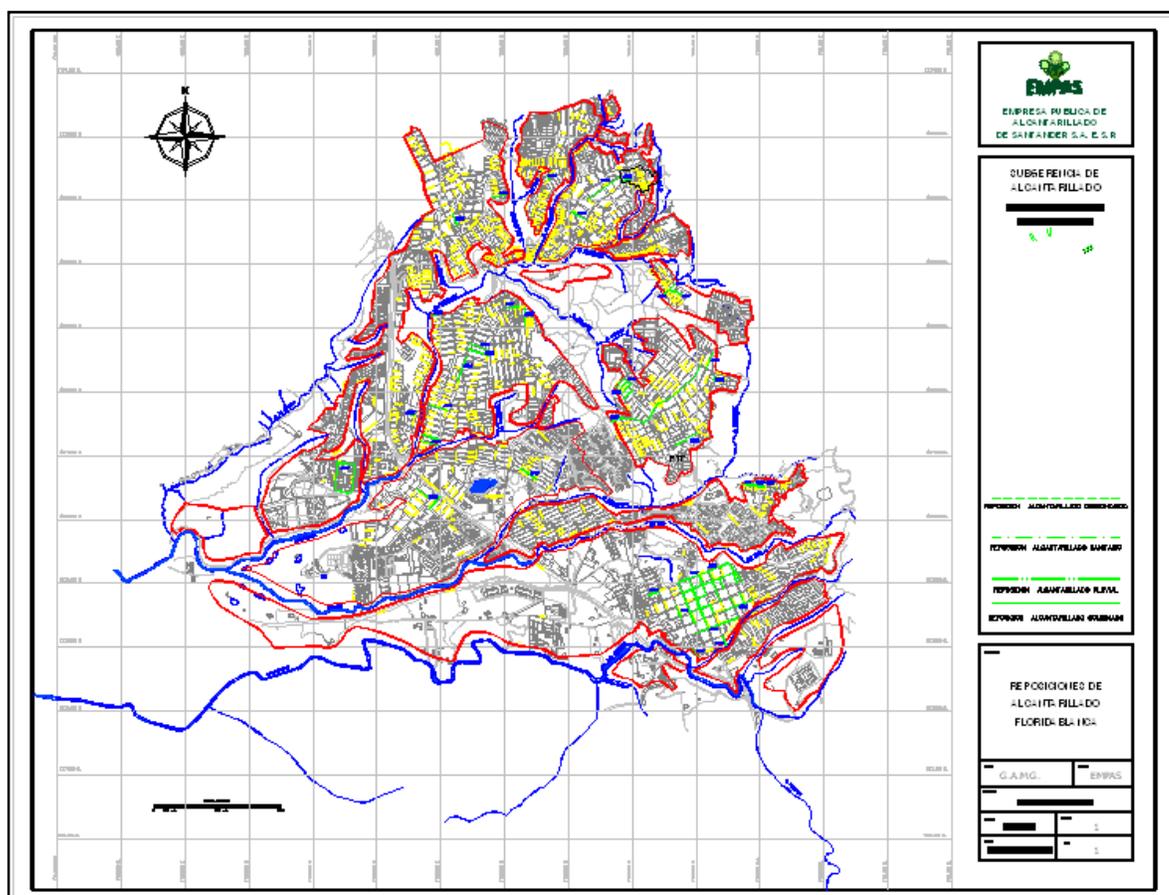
Plano de reposiciones de las redes de alcantarillado de Floridablanca
